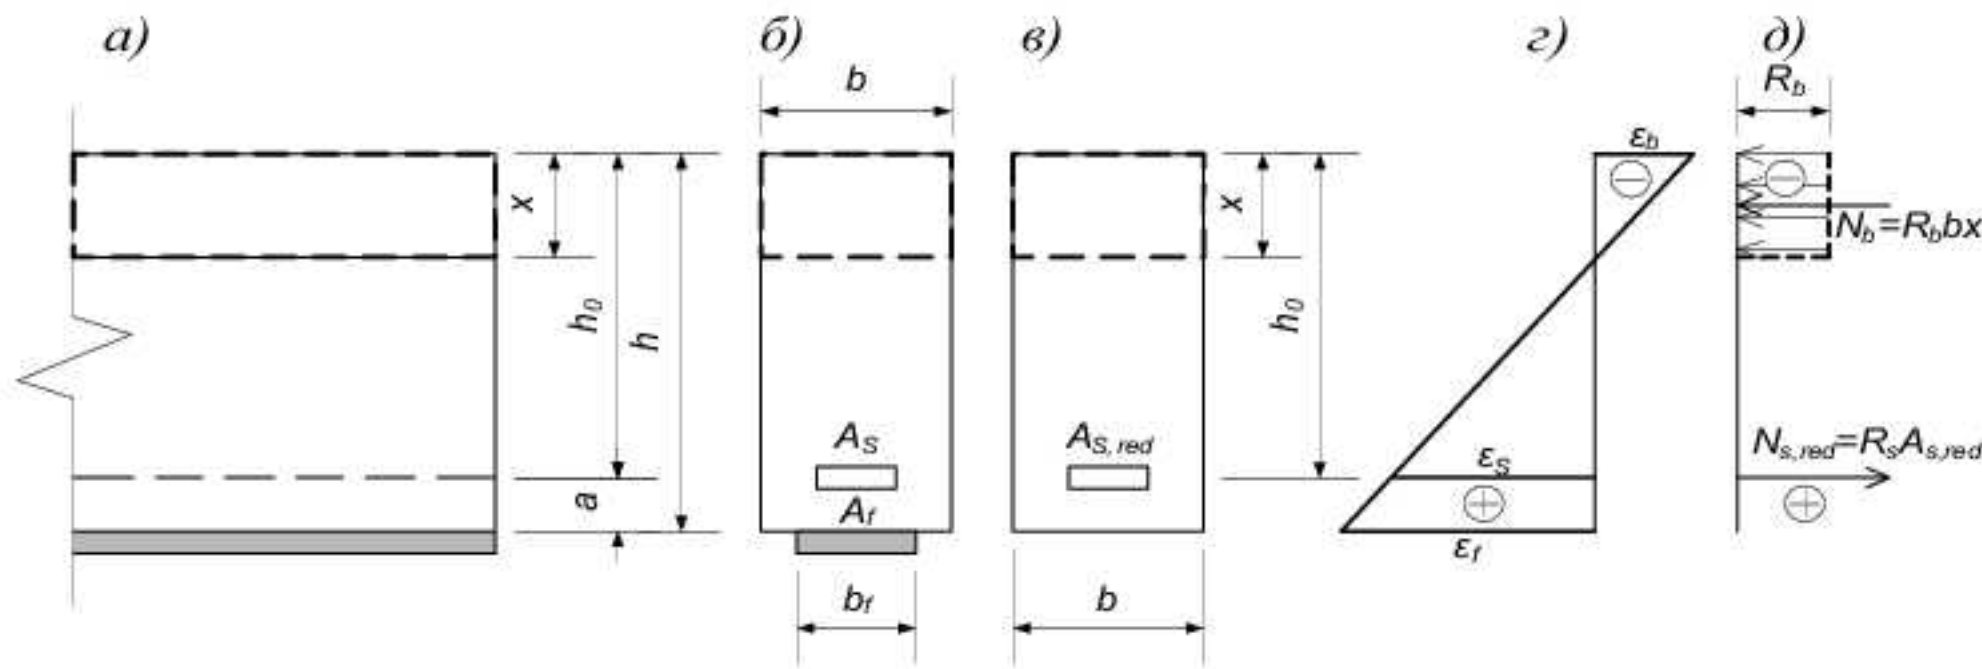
Розрахункова схема нормального перерізу залізобетонної балки, підсиленої зовнішньою композитною арматурою
